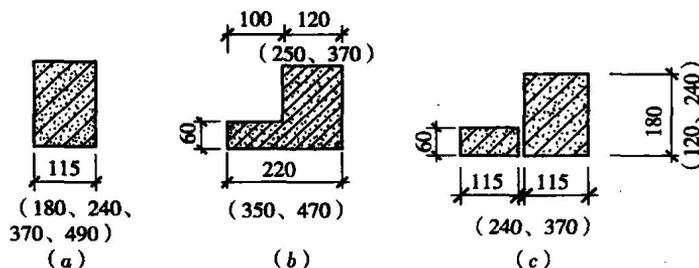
钢筋混凝土过梁截面形式和尺寸 (mm)
